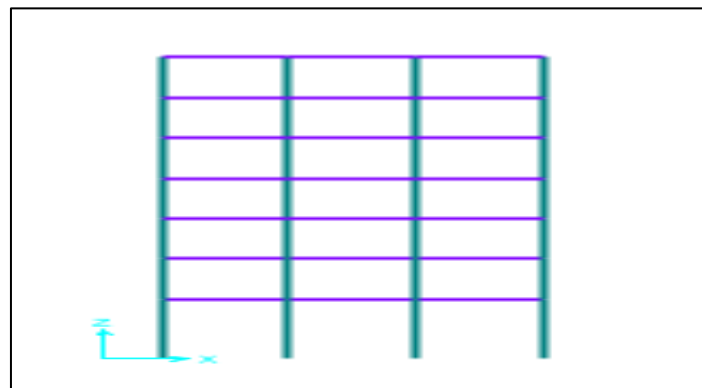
Vue des poteaux et poutres du bloc C.
